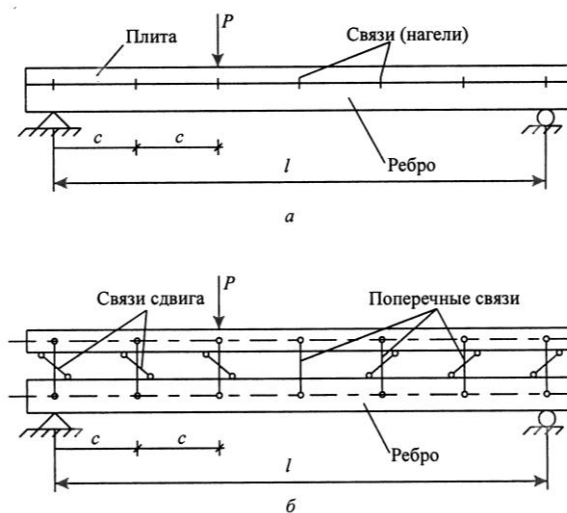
Деревожелезобетонная балка – составная стержень: а – нагельное соединение ветвей; б – схема связей
